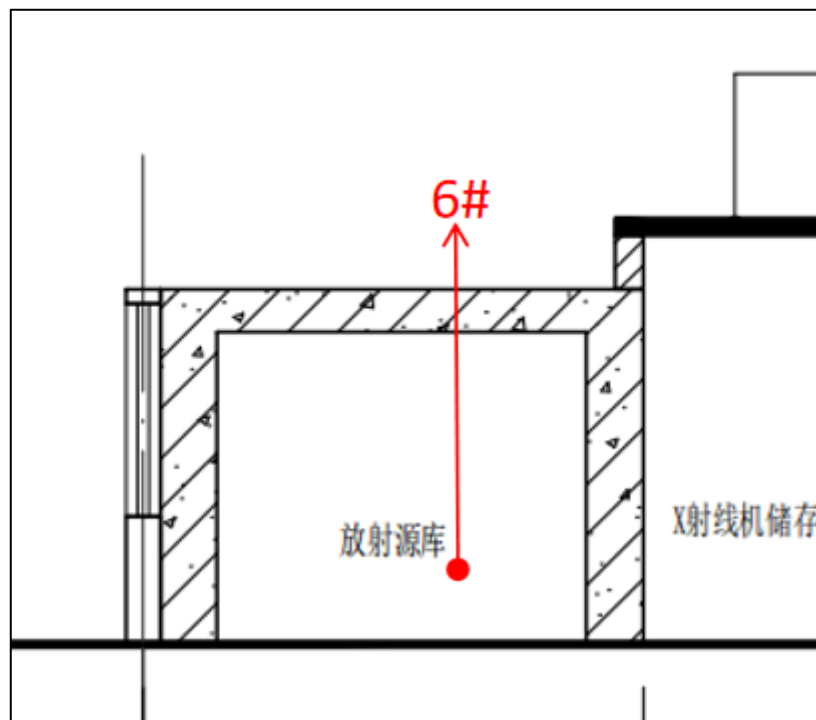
放射源暂存库平面布局及预测点位示意图（单位：mm）
